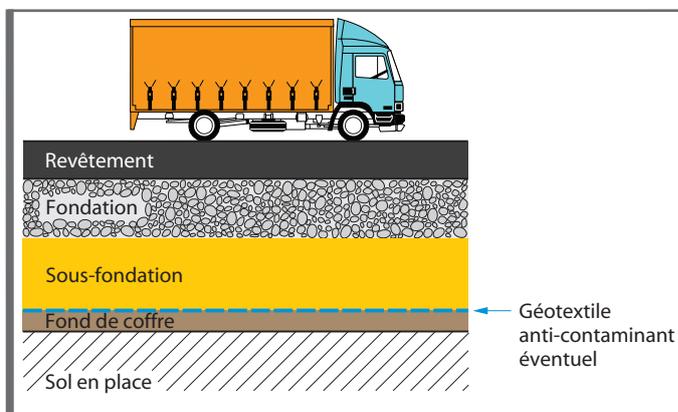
Schéma de principe d'une structure de chaussée à revêtement imperméable (pas à l'échelle)
